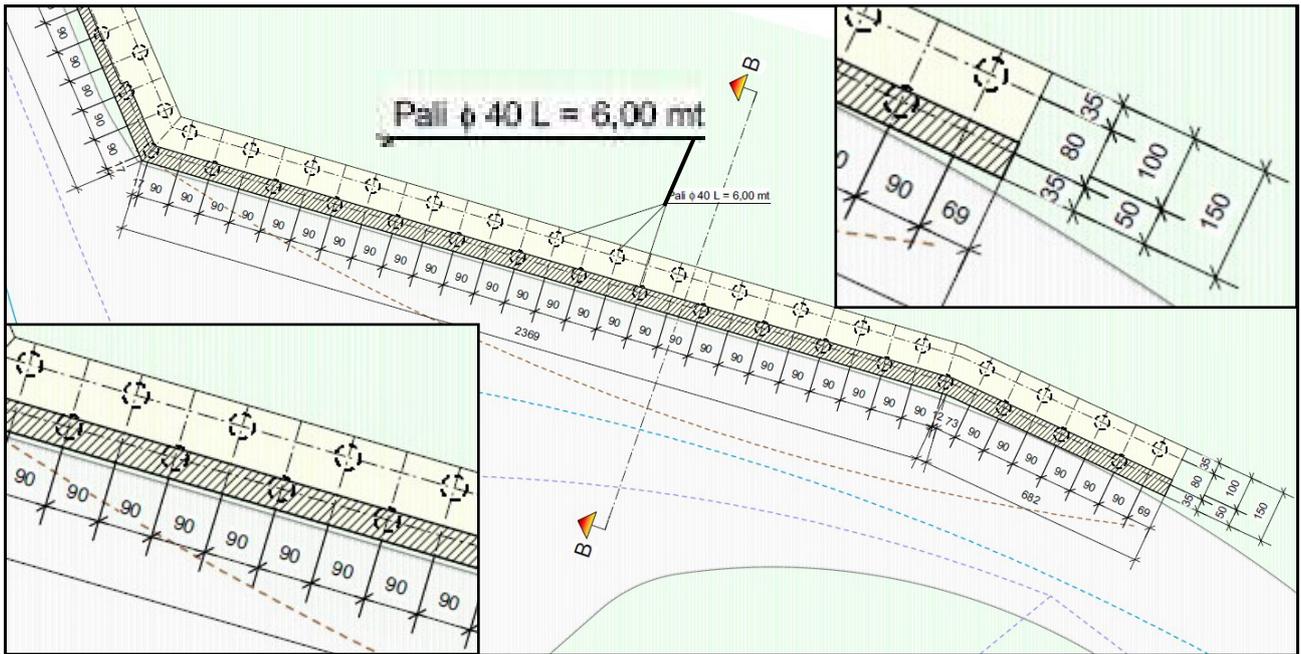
planimetria dell'opera nel tratto di Via della Valle – lunghezza 30 m
